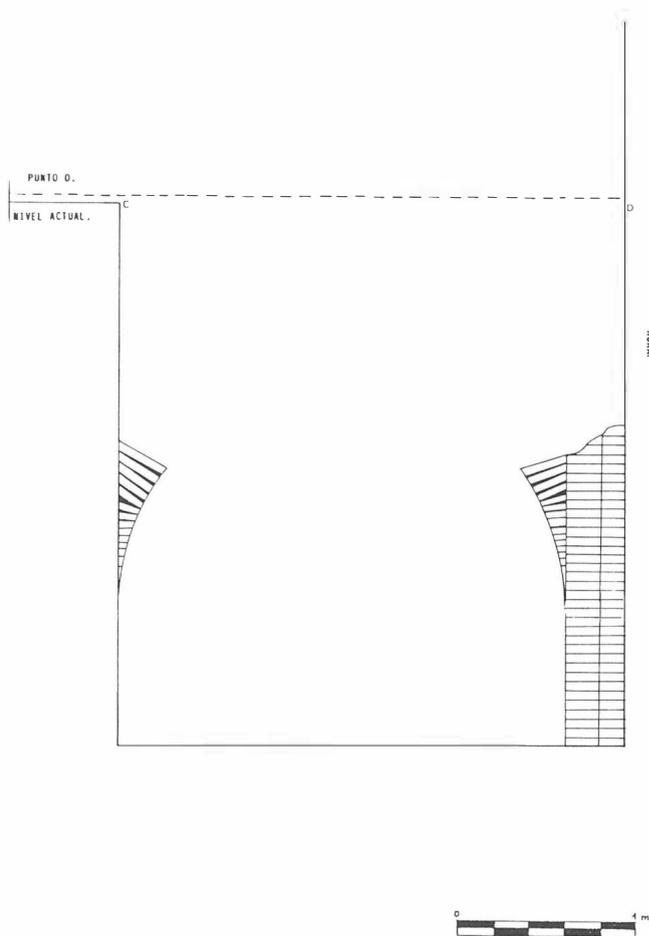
Murallas del Valle (1986). Corte I. Sección C-D.
